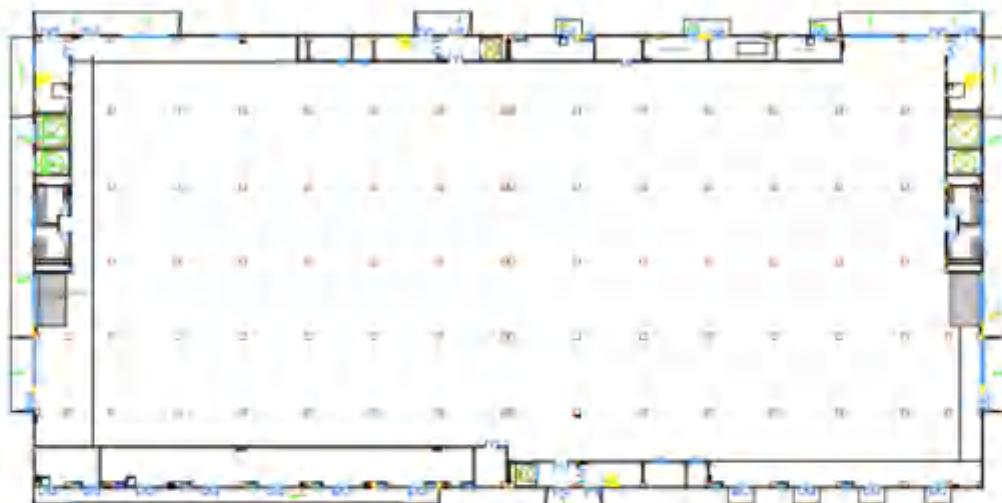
4#1/3/5F 平面布局图（仓库）
